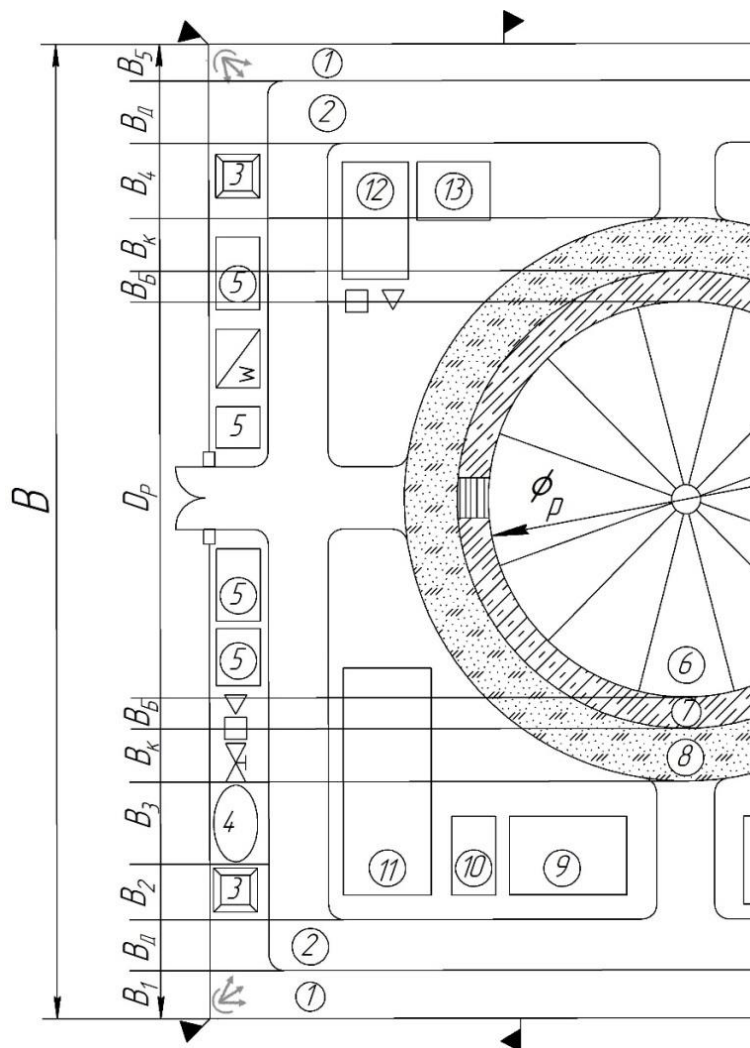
Схема планировки для расчета ширины монтажной площадки:
